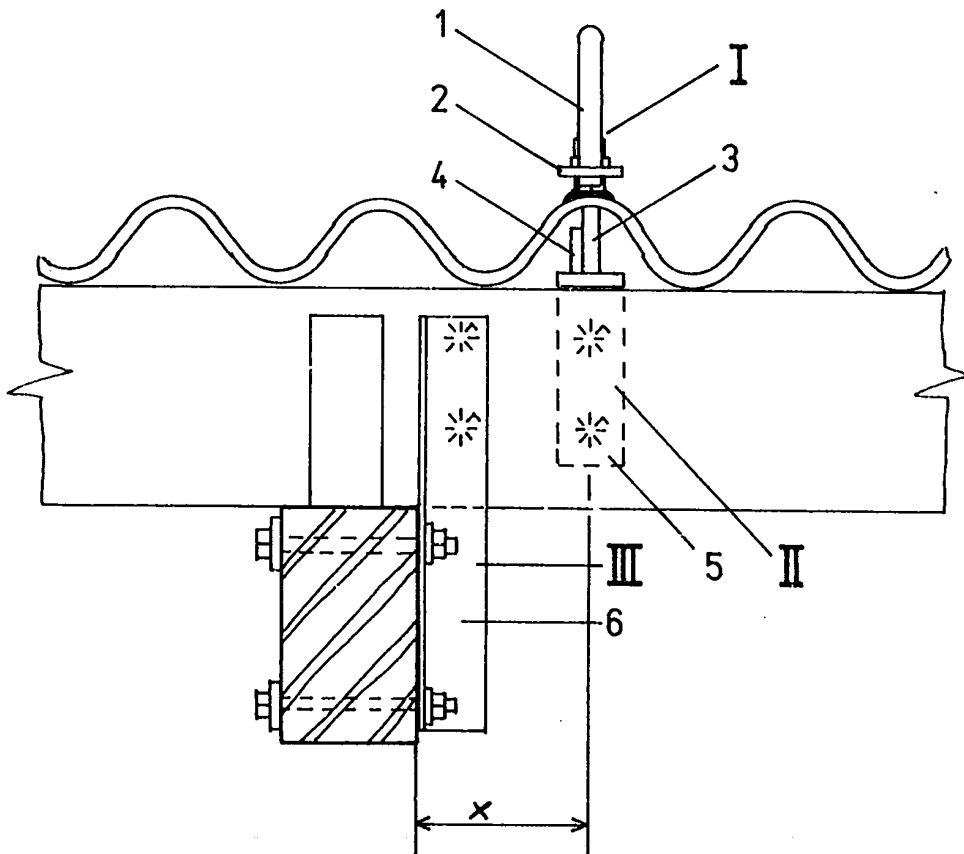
stellt das Bauteil II dar, bestehend aus einem Stehbolzen 3, einem eingeschweißten Knotenblech 4 und einem abgekanteten Flachstahl 5 mit Bohrungen.
